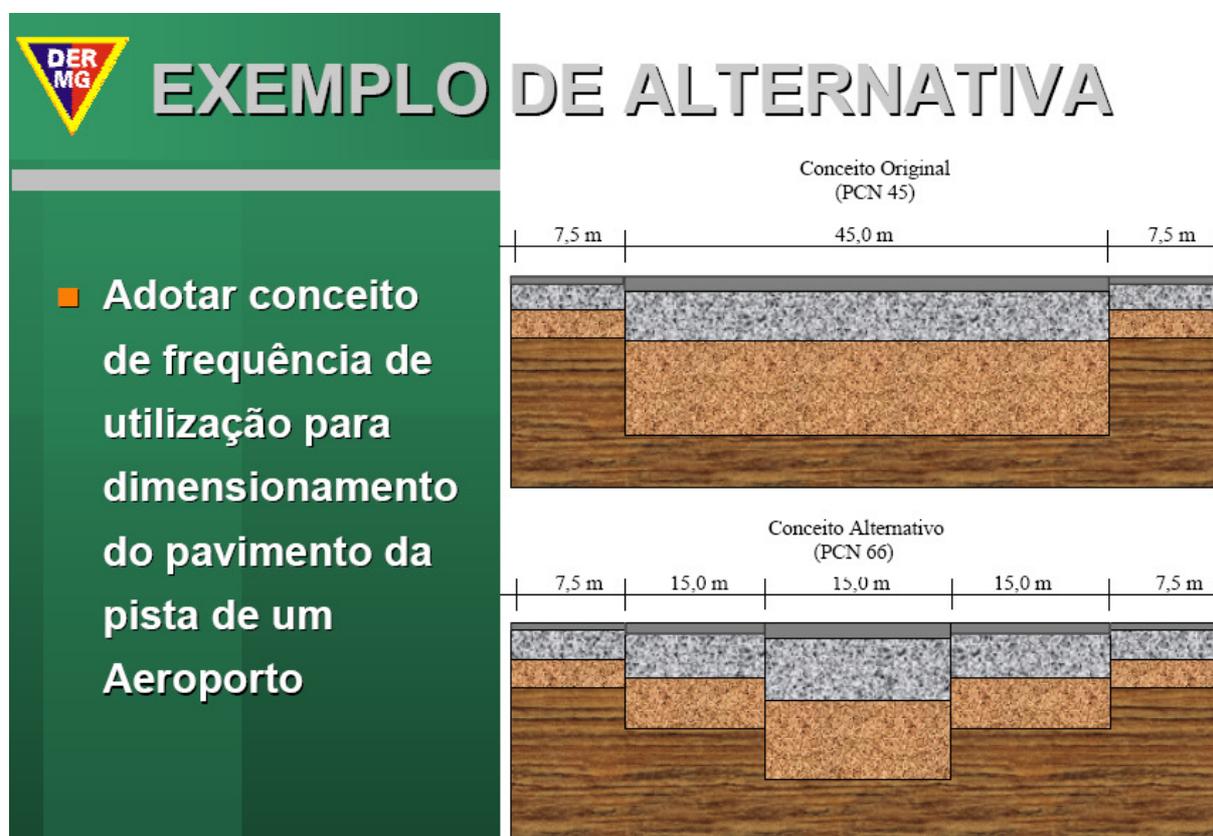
Conceito Alternativo para o Pavimento da Pista do Aeroporto – JF / MG
